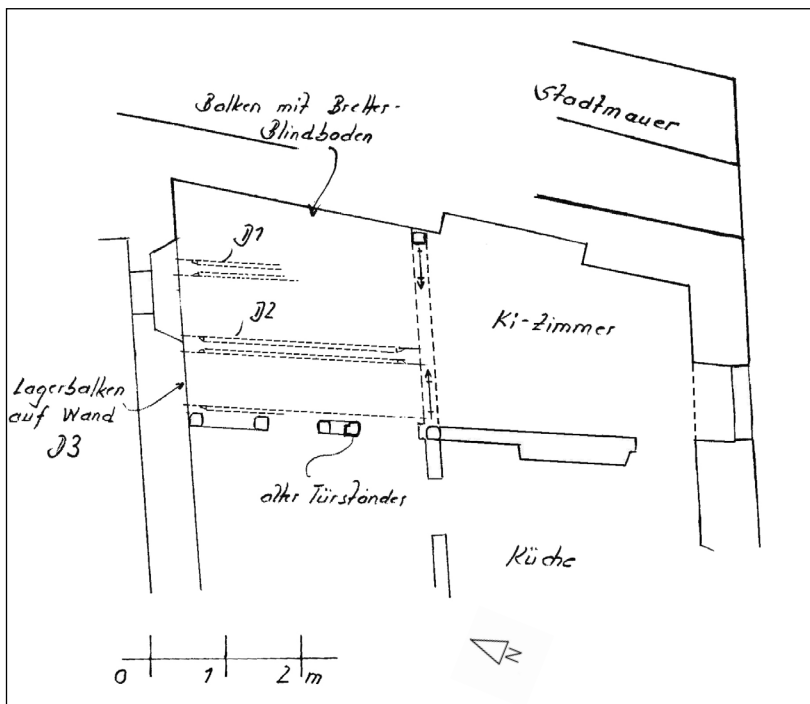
St. Johannesgasse 15, Grundriss Erdgeschoss (Ausschnitt), 1477(d).
